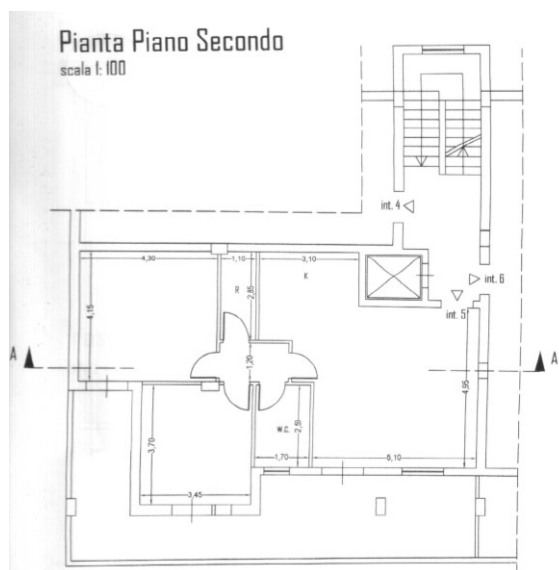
planimetria urbanistica secondo l’istanza di condono ex Legge n.724/94 prot. n.436 del 09/01/1995 dell’appartamento al secondo piano
